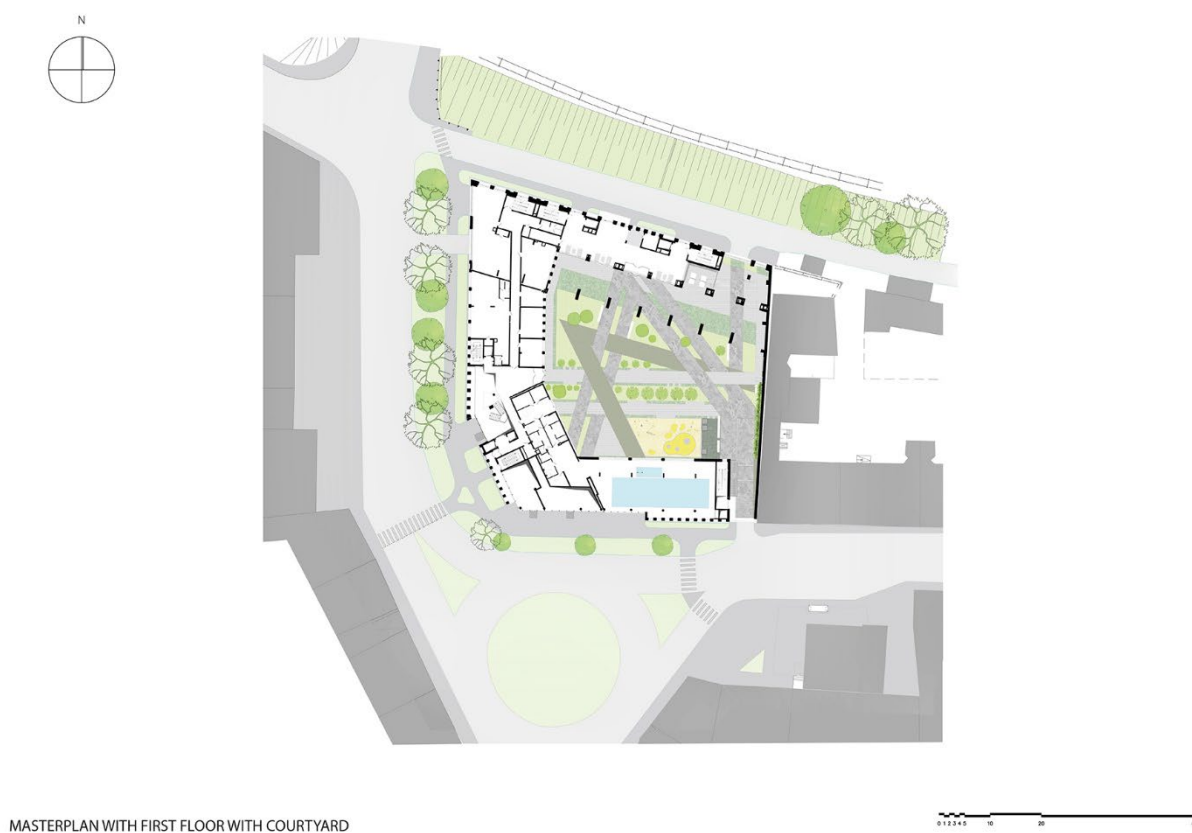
План 1-го поверху Forum Apartments [39]
